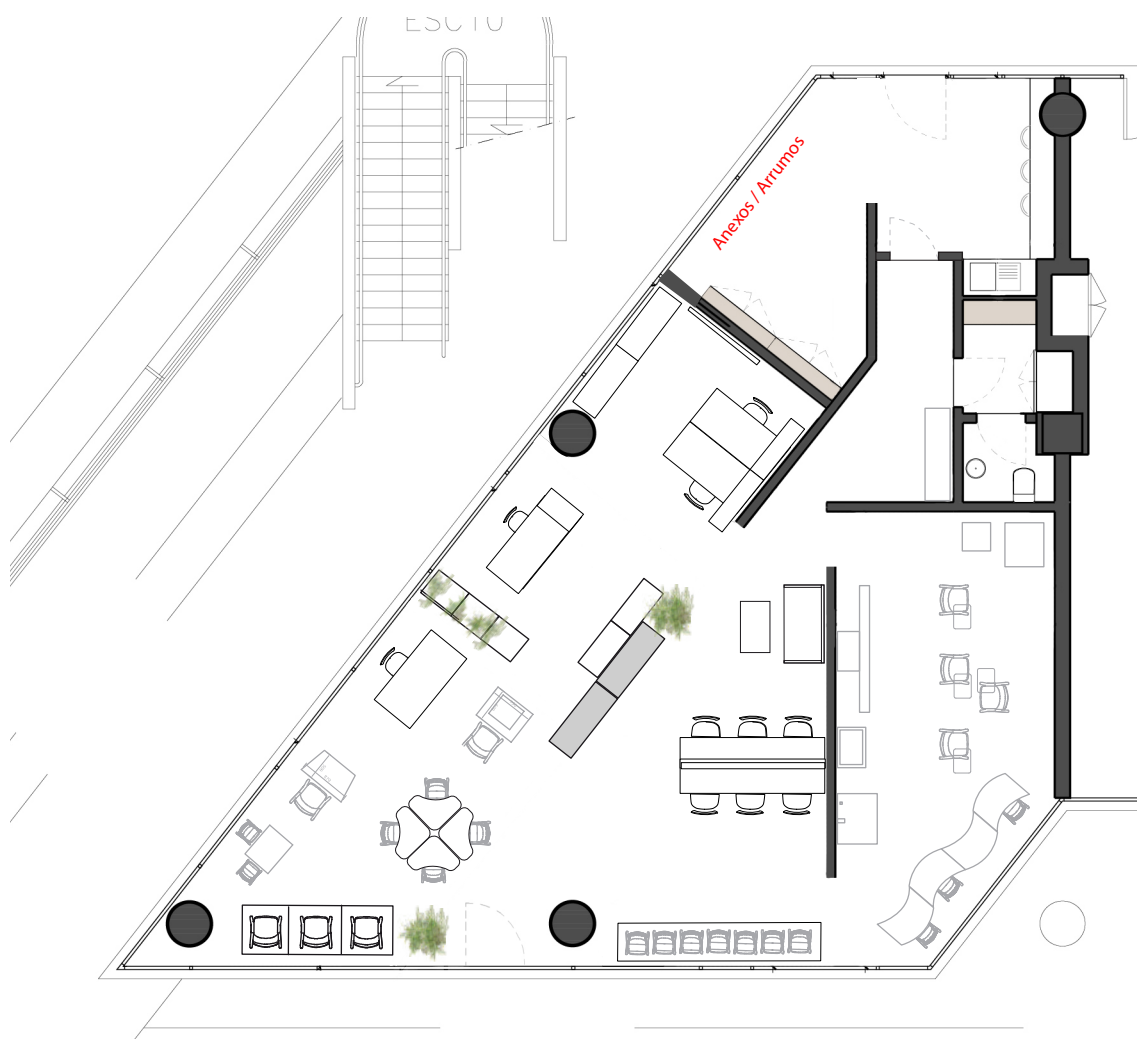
Planta final do espaço em Lisboa da NAUTILUS
